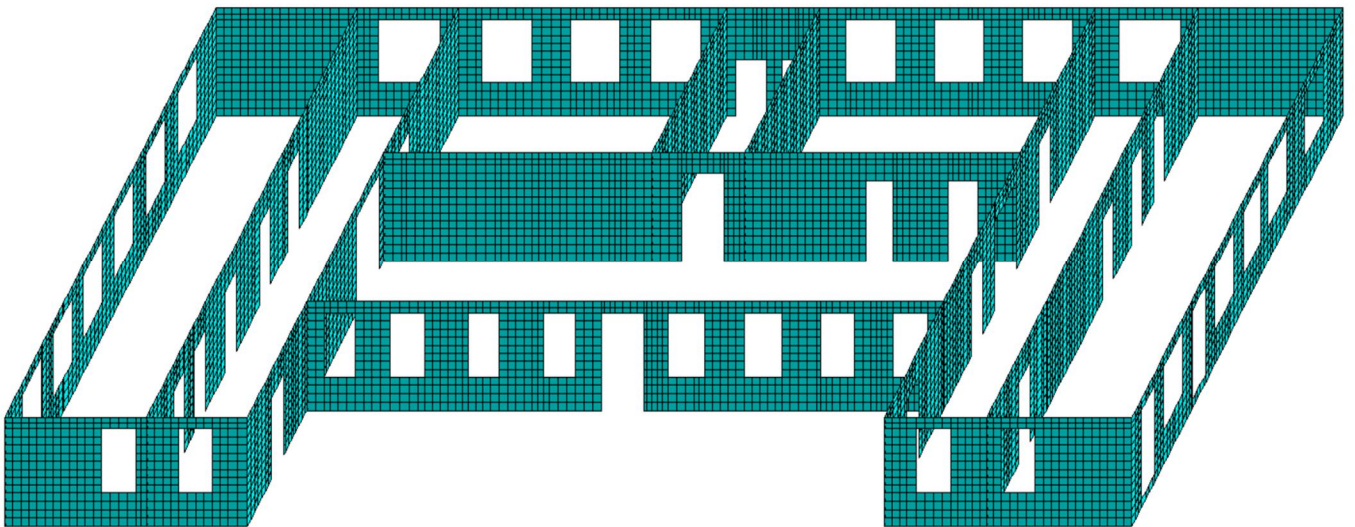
Розрахункова схема несучих конструкцій першого поверху будівлі.
